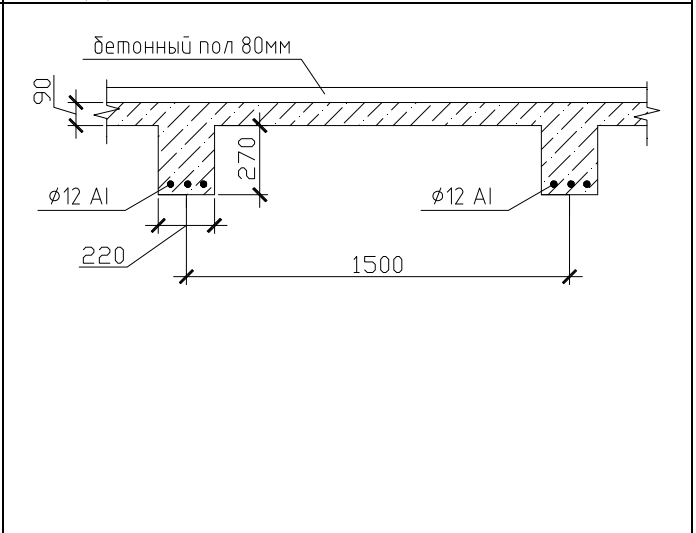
Второстепенная балка ж/б перекрытия над вторым этажом в осях «8-11/А-В, Б-Г»
